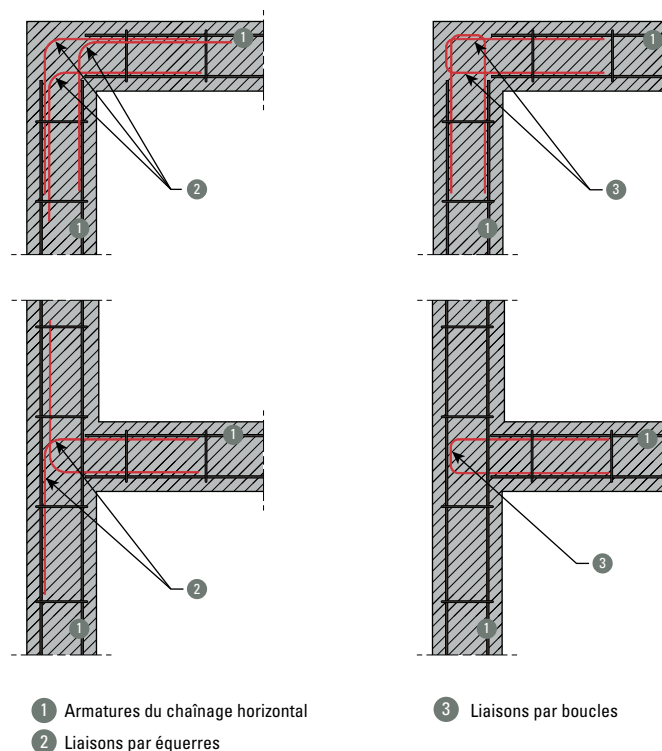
Exemples de liaisons entre armatures de chaînages horizontaux en zone courante
